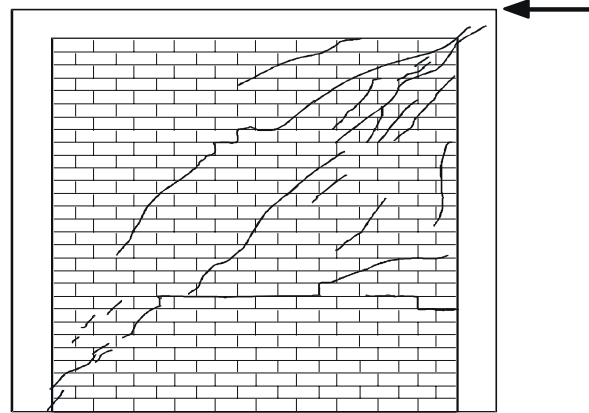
Ensaye en voladizo de un muro de mampostería confinada (Meli, 1979)
